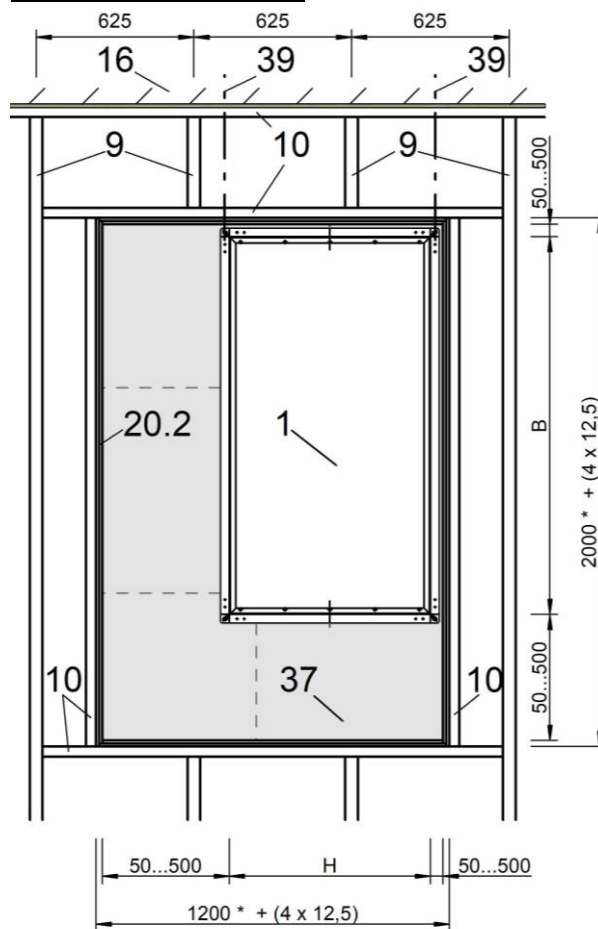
montaggio nella parete con struttura di supporto metallico (spessore parete = 100 mm)
